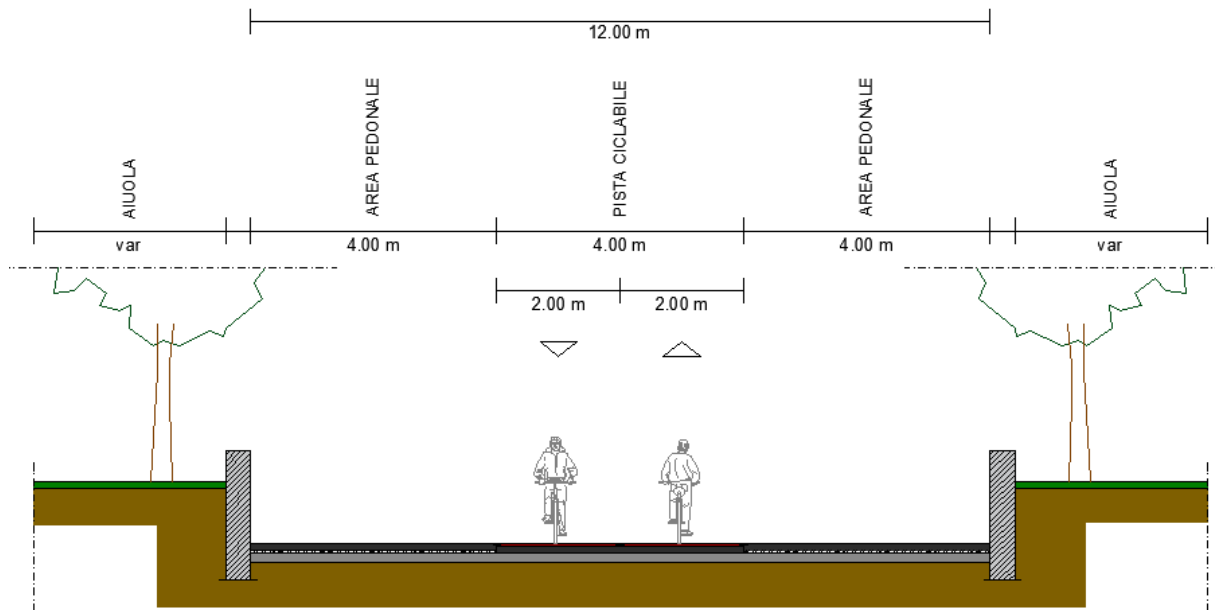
piazzale Tecchio, sezione trasversale di progetto.
